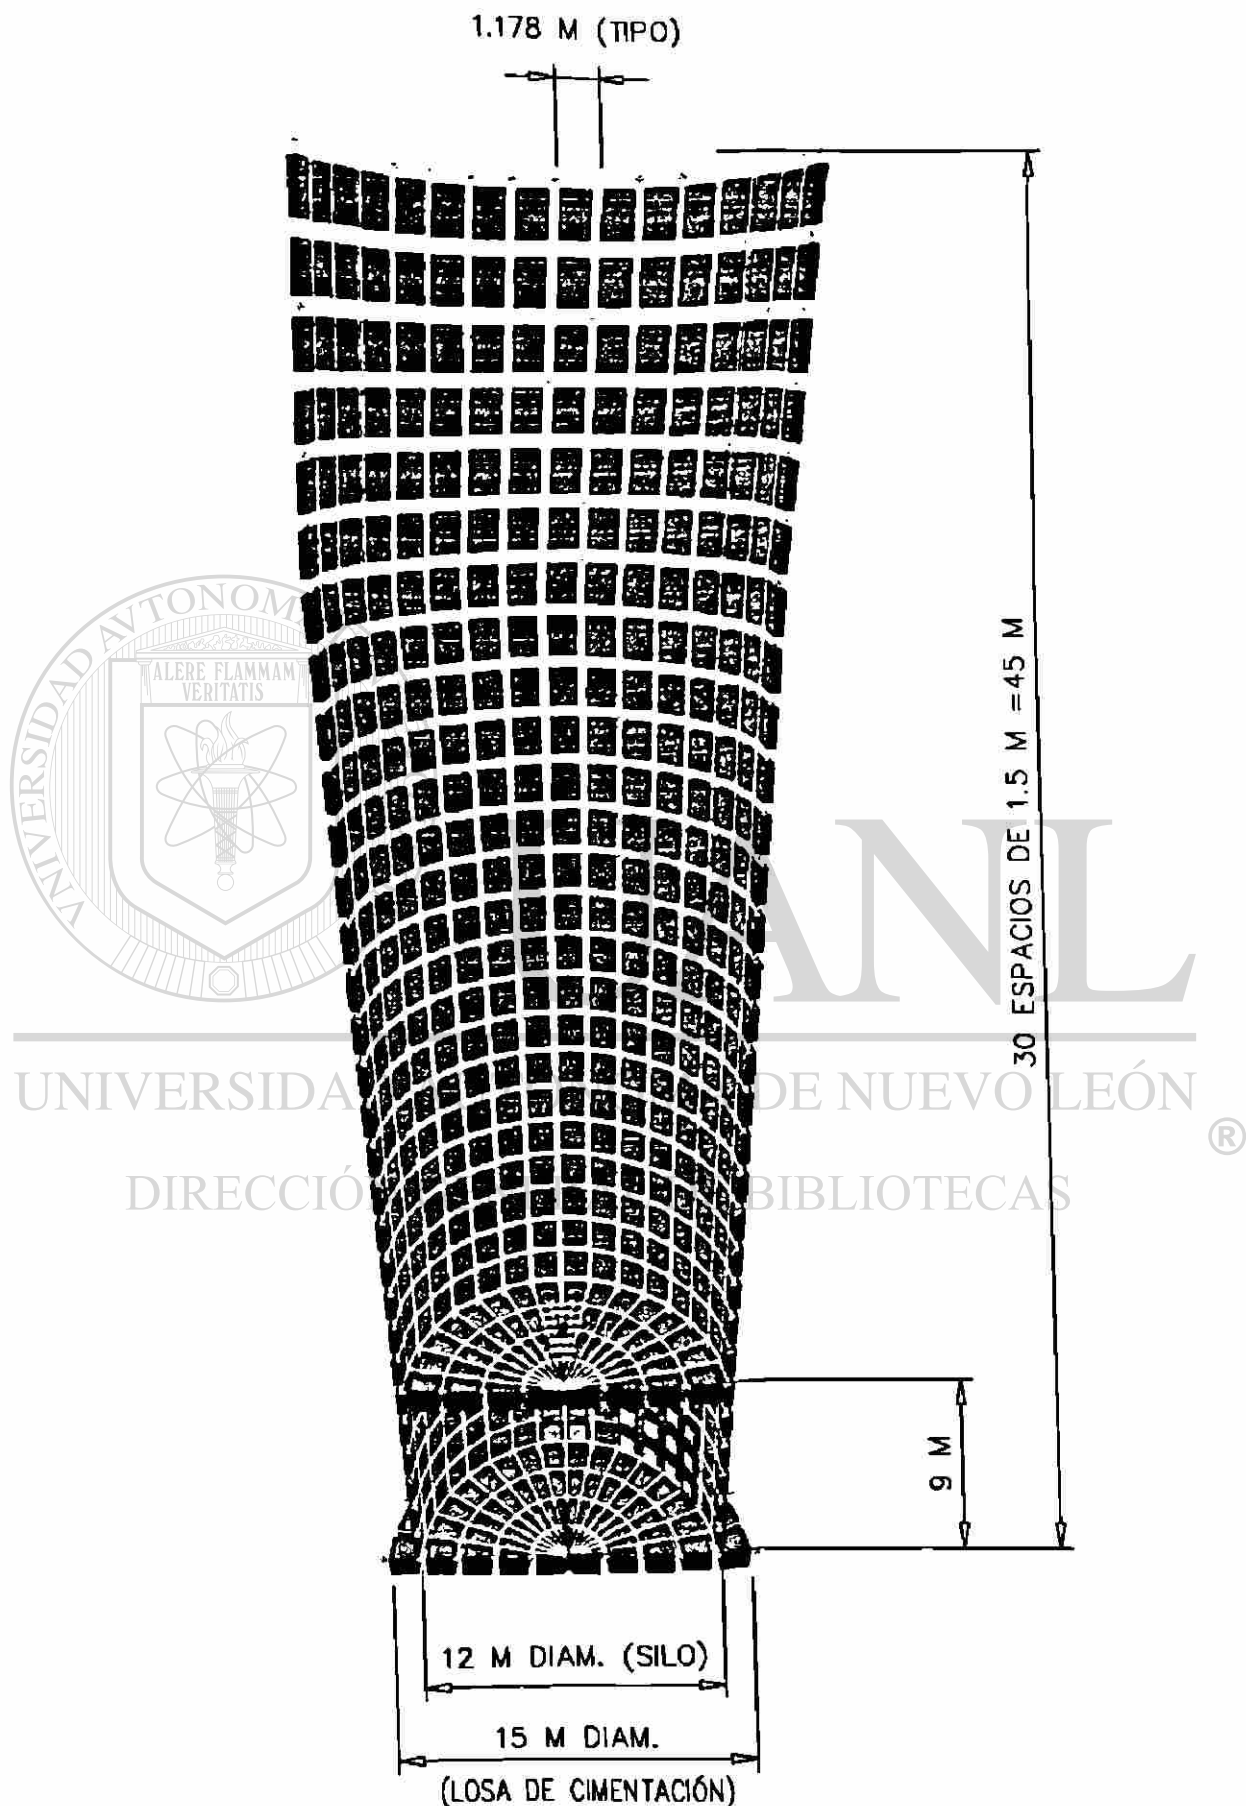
Geometría de medio silo de 12 m diam., $H/D = 3$ y losa de fondo plana.
